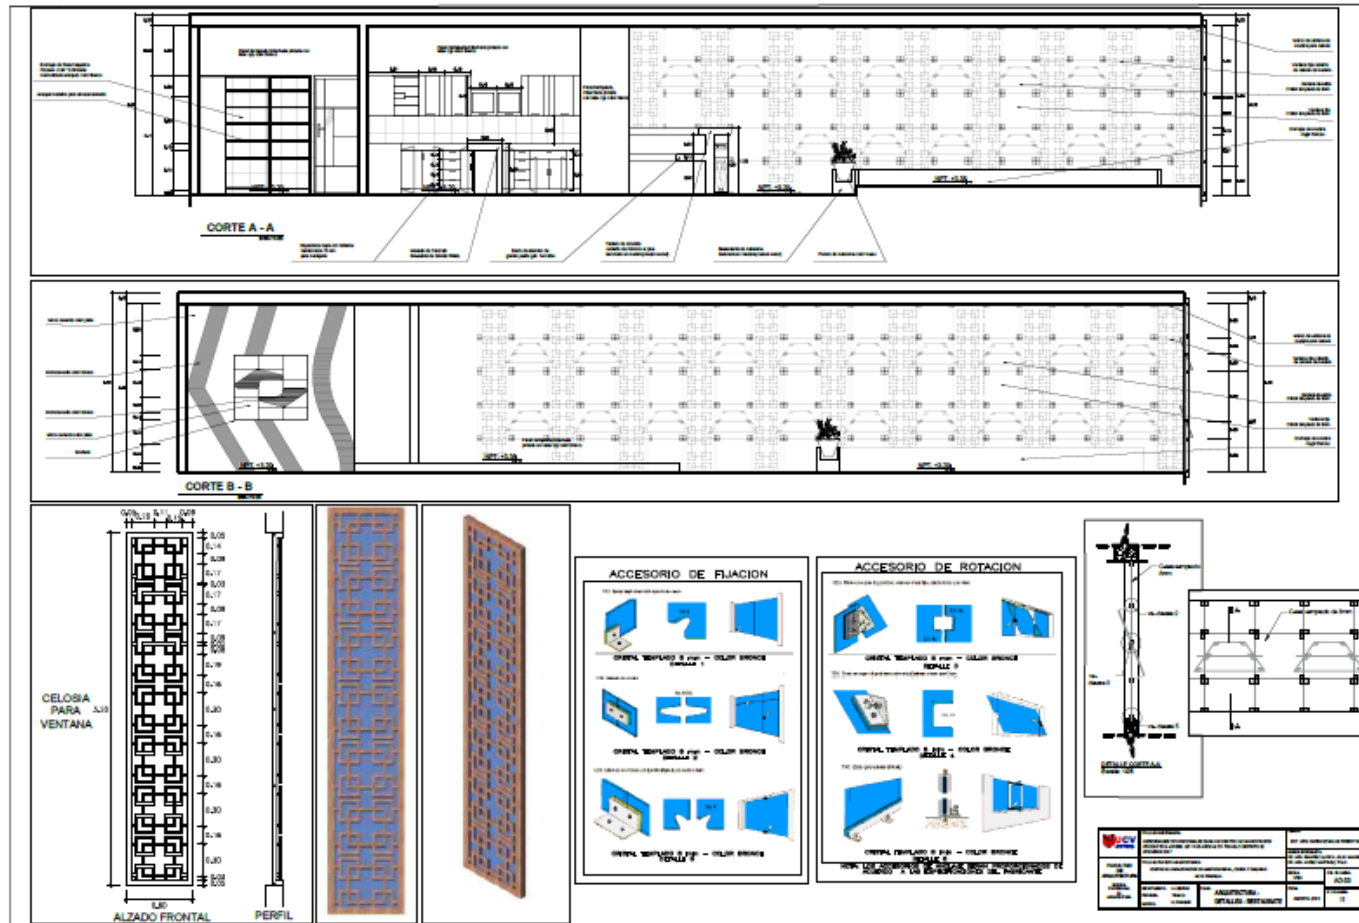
Plano de Detalle Arquitectónico, Corte y detalle de vanos y celosías del restaurante -Plano N°11-Lámina AD03
